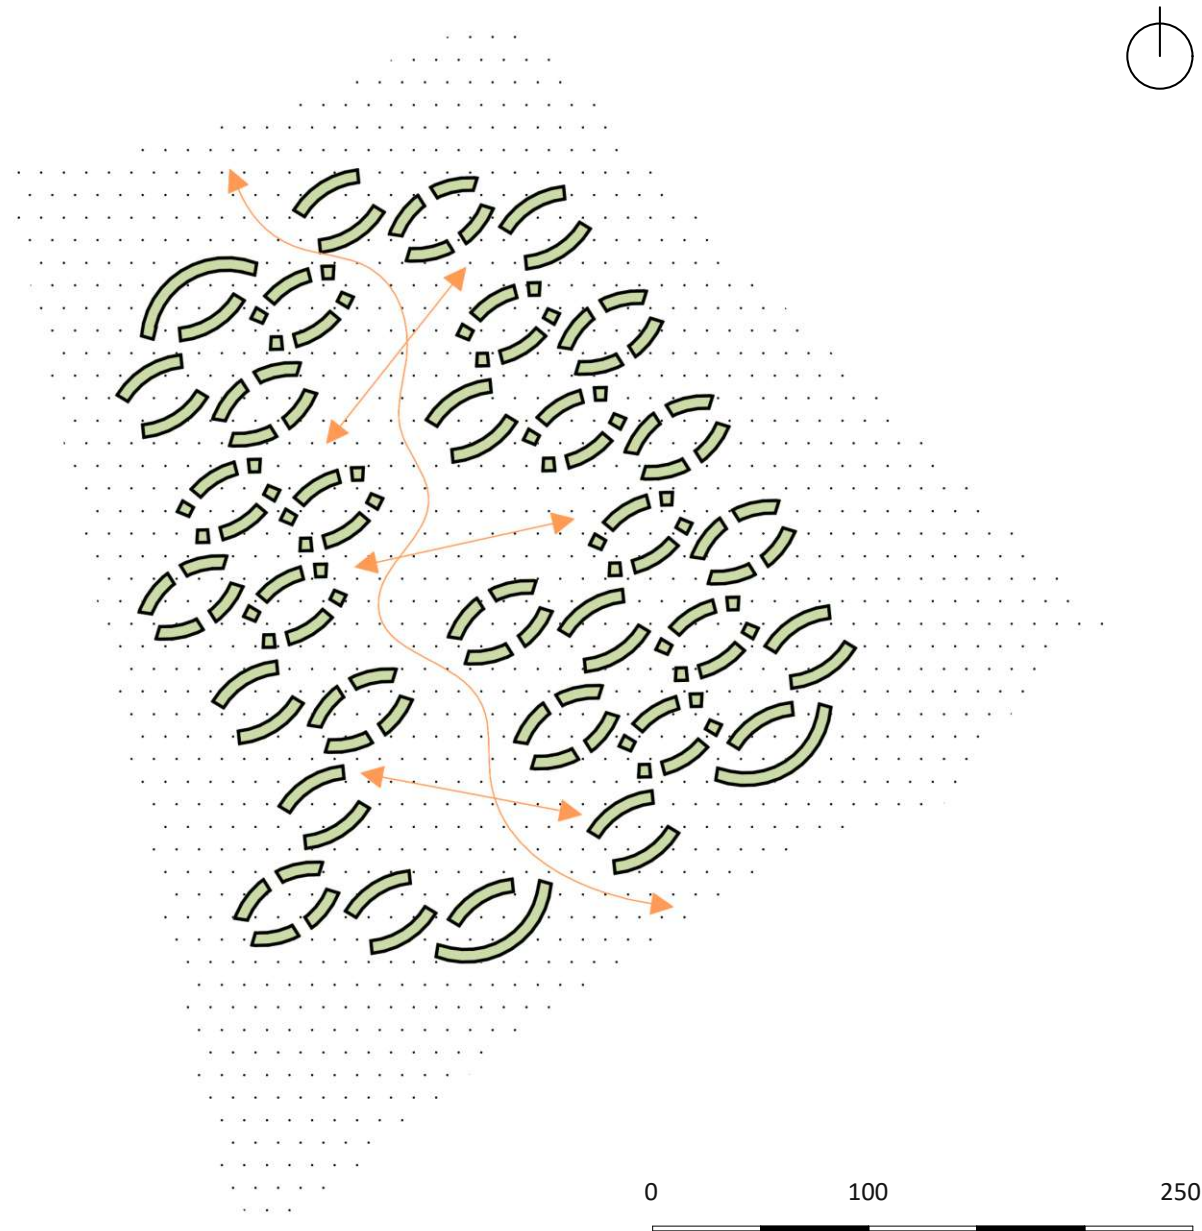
| Grundriss der 1.Variante 1a
